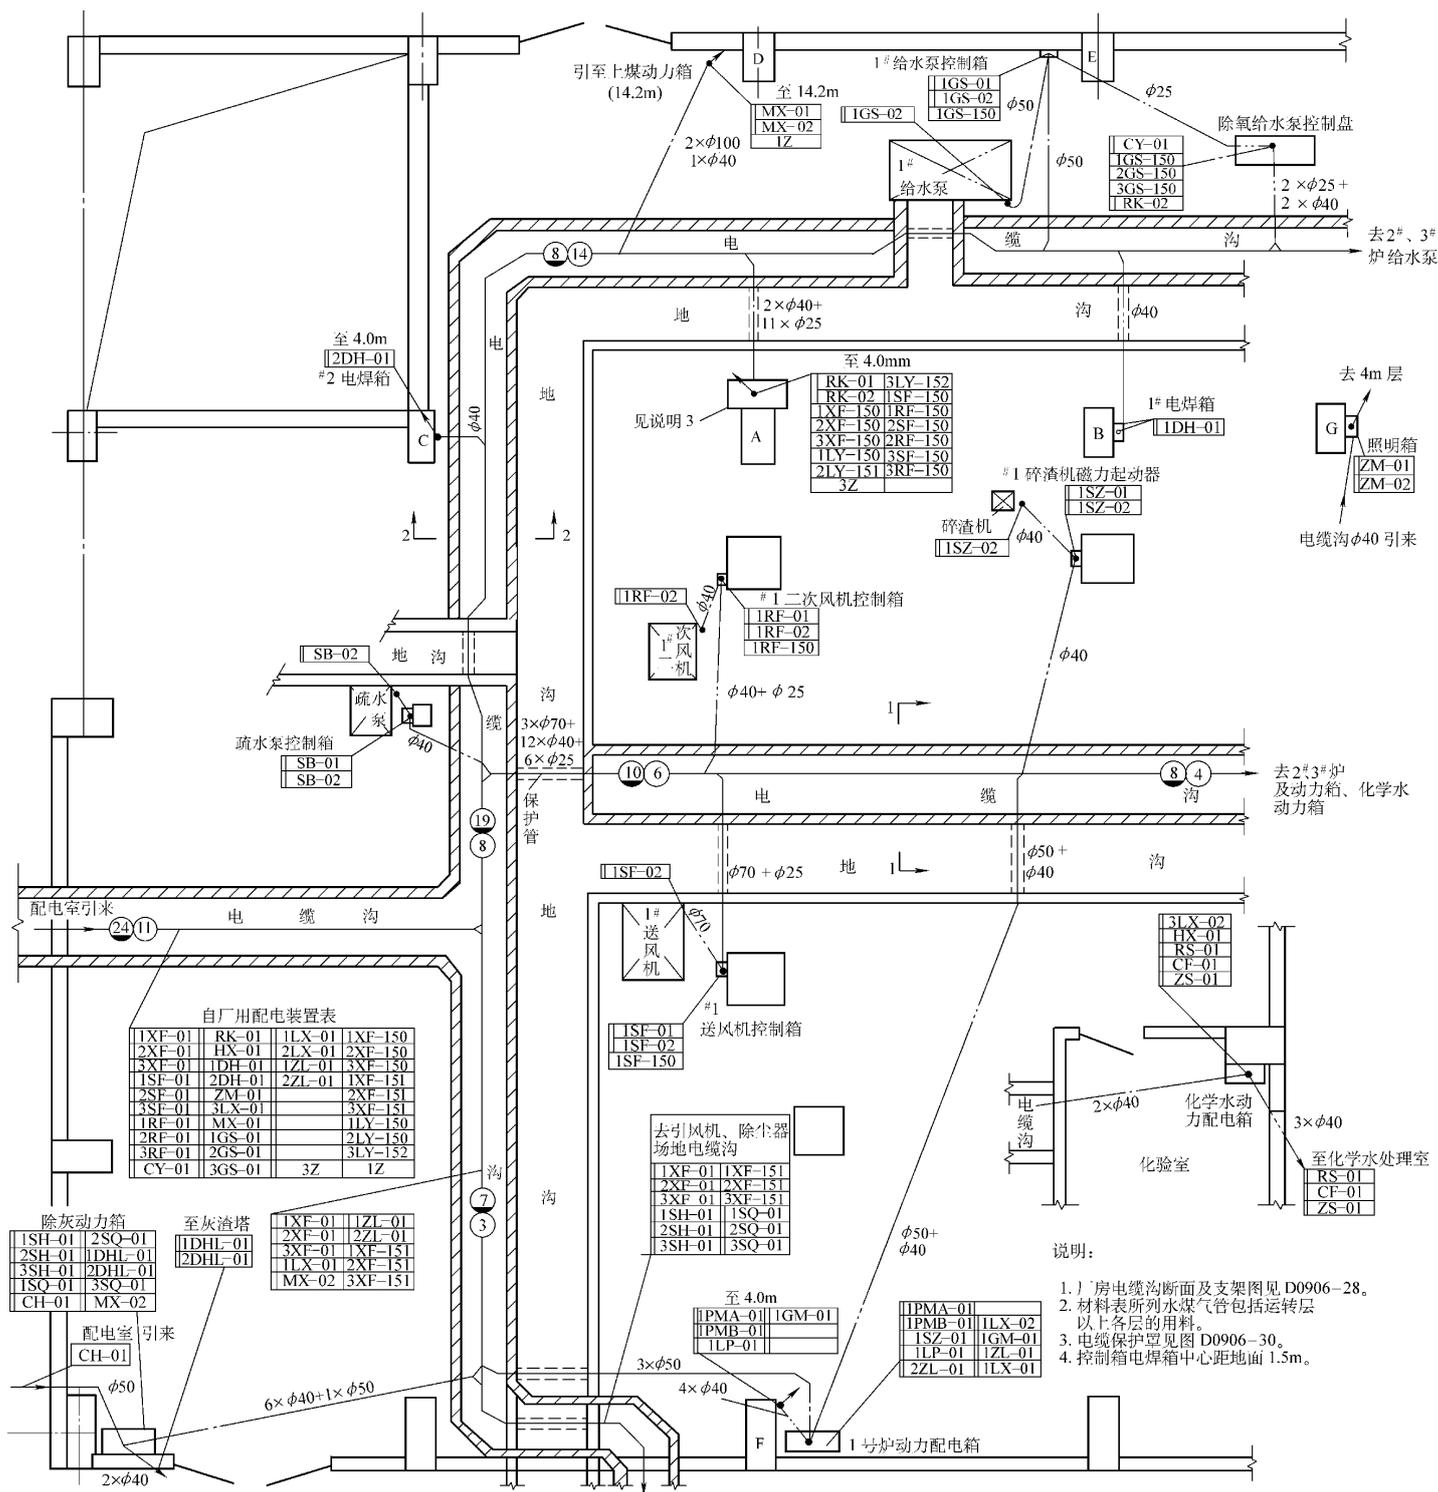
锅炉房 0m 标高电缆敷设平面图 (局部)
